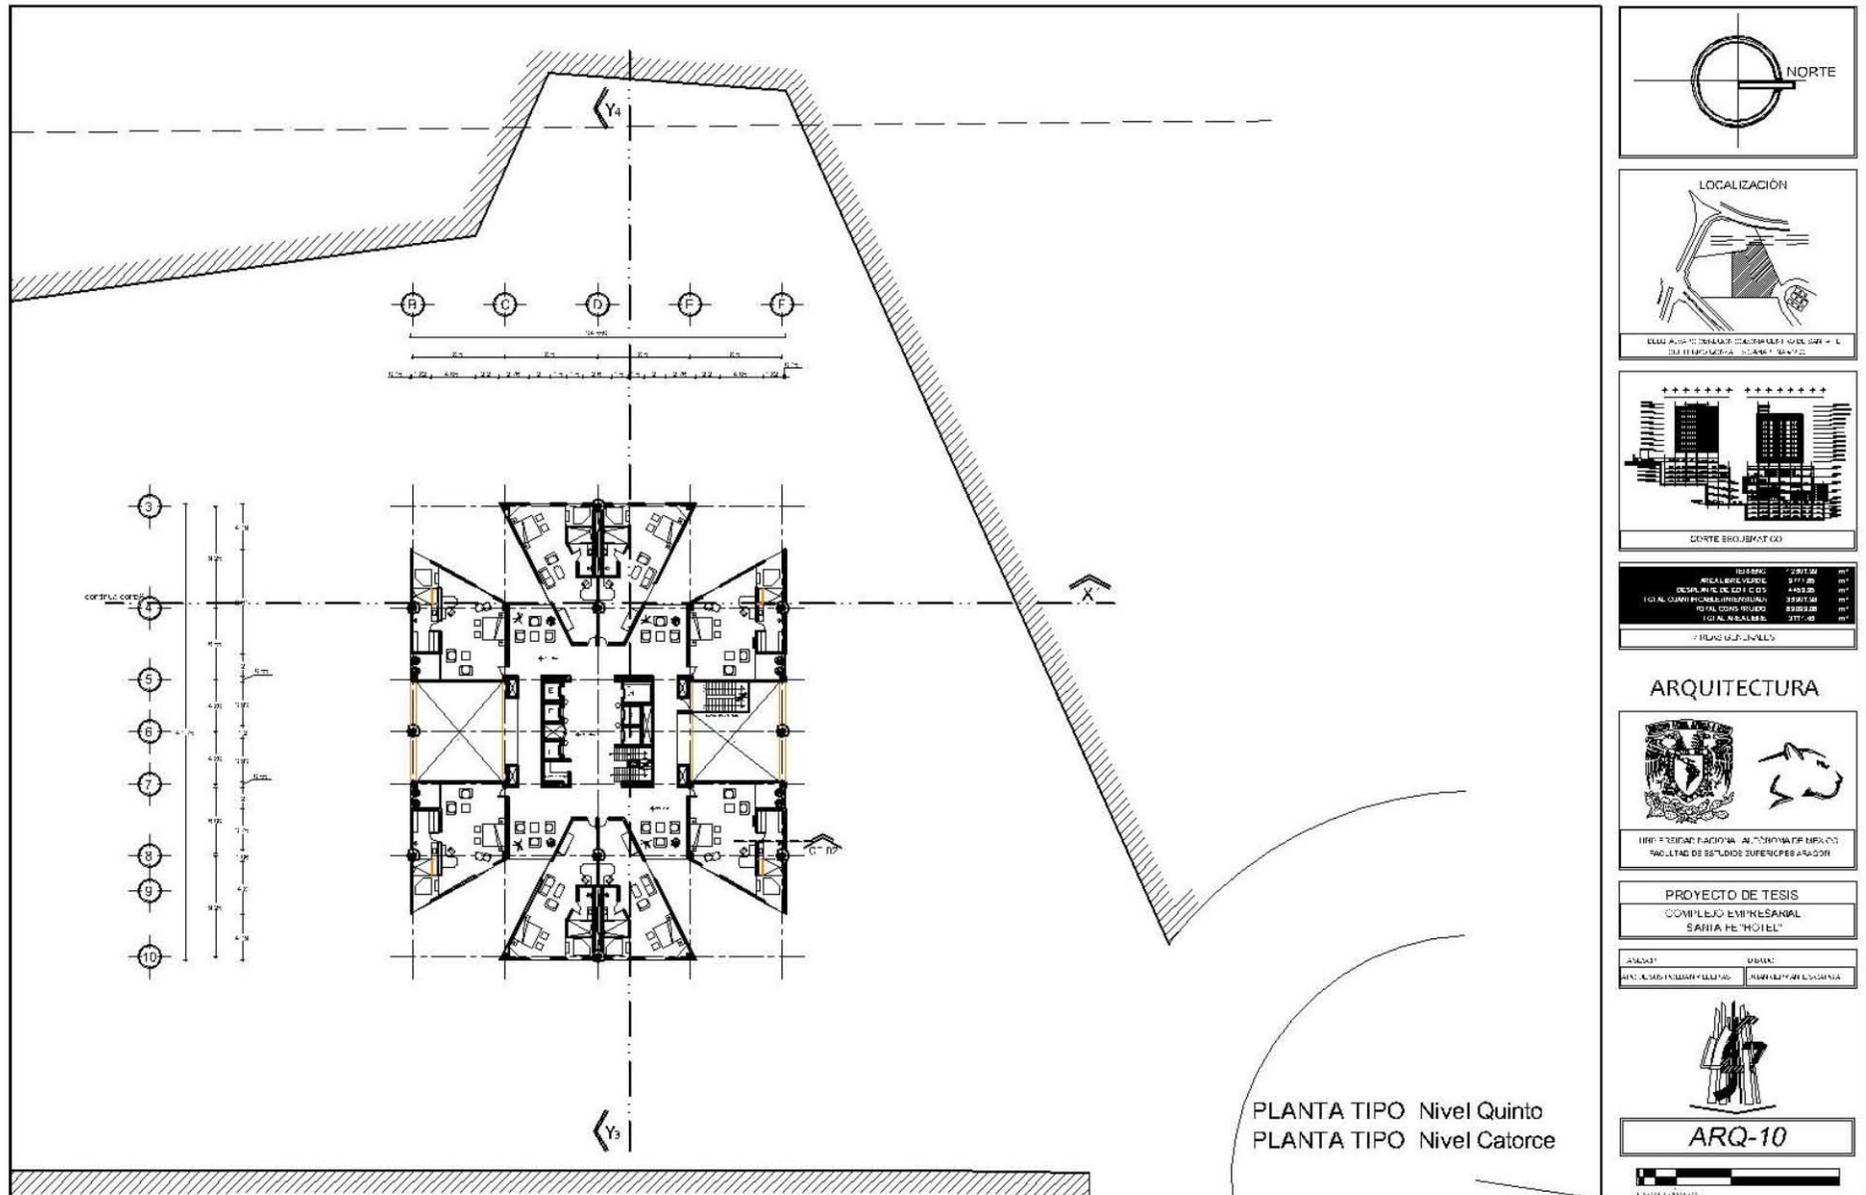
Plano ARQ-10; Planta Tipo Quinto-Catorce Nivel Hotel. Edición propia.
